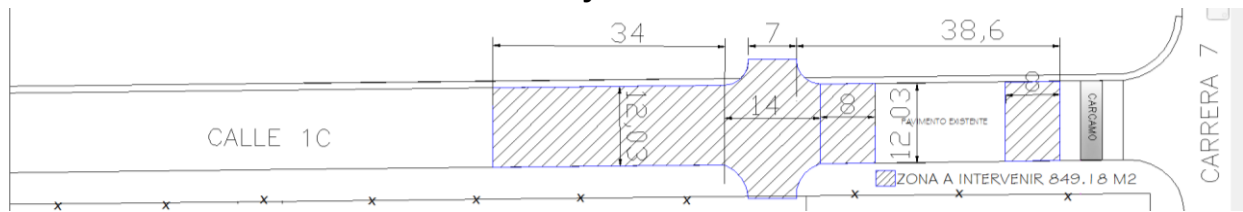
Planta profícol, área a intervenir. Fuente Propia
